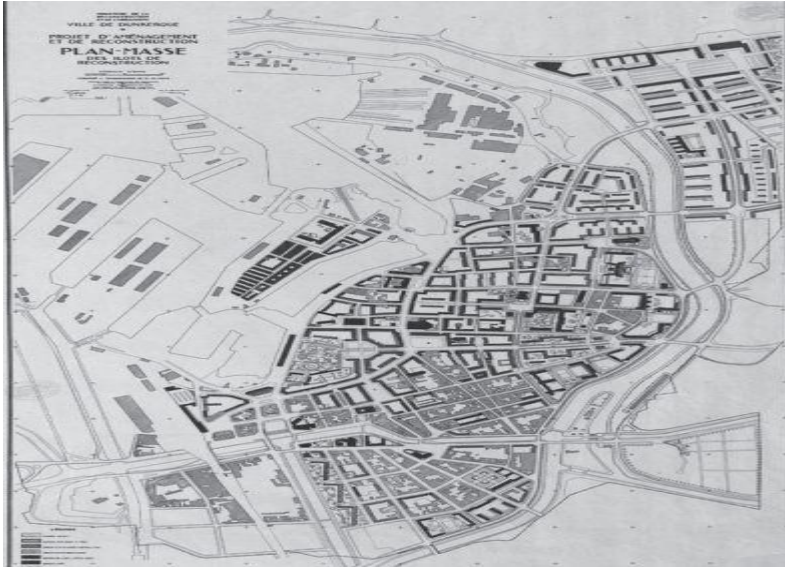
Plan d'aménagement et de reconstruction de Leveau
